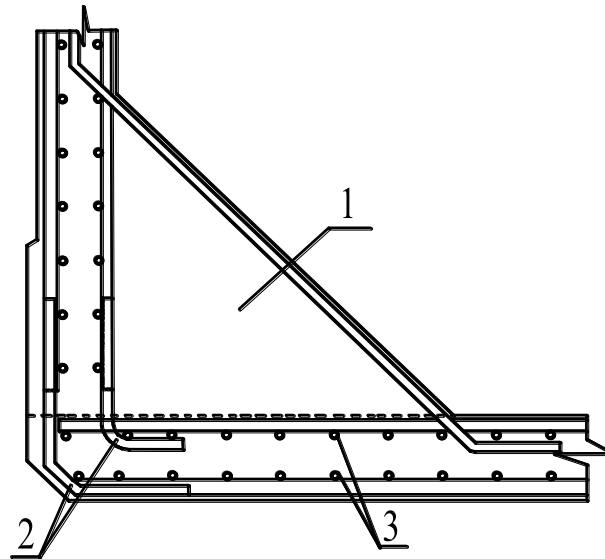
Удосконалена конструкція вузла з'єднання днища та зовнішньої поздовжньої стінки понтона композитного плавучого доку: 1 – бетонна книця, 2 – поперечна арматура, 3 – поздовжня арматура
